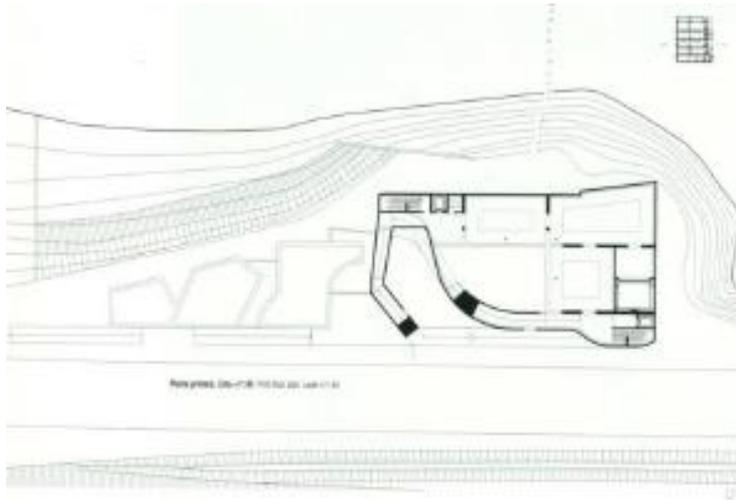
Planta baixa - primeiro pavimento – cota +11.40
